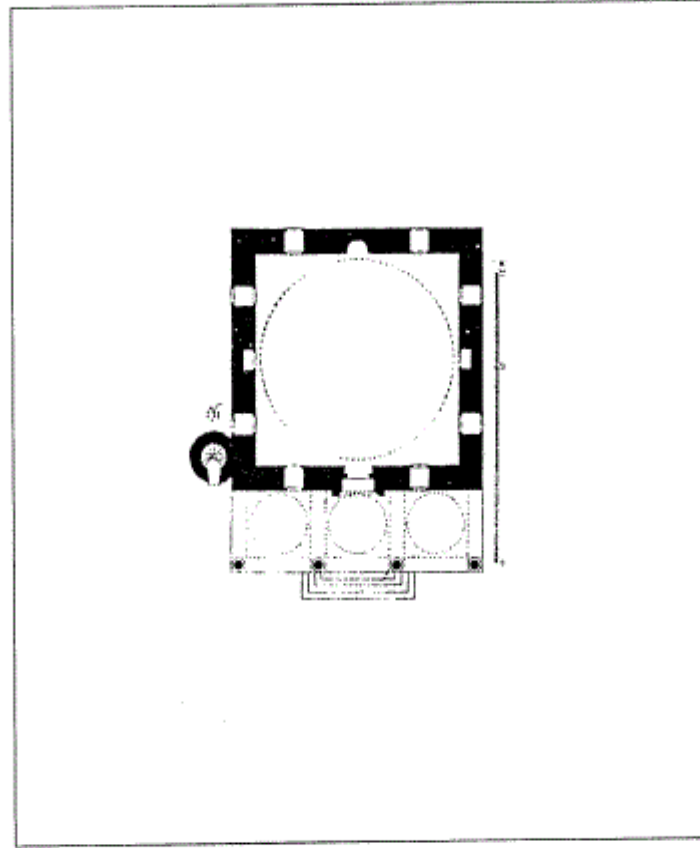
مسقط أفقي لمسجد قاسم باشا في أدرنة (عن: اصلان ابا) .
